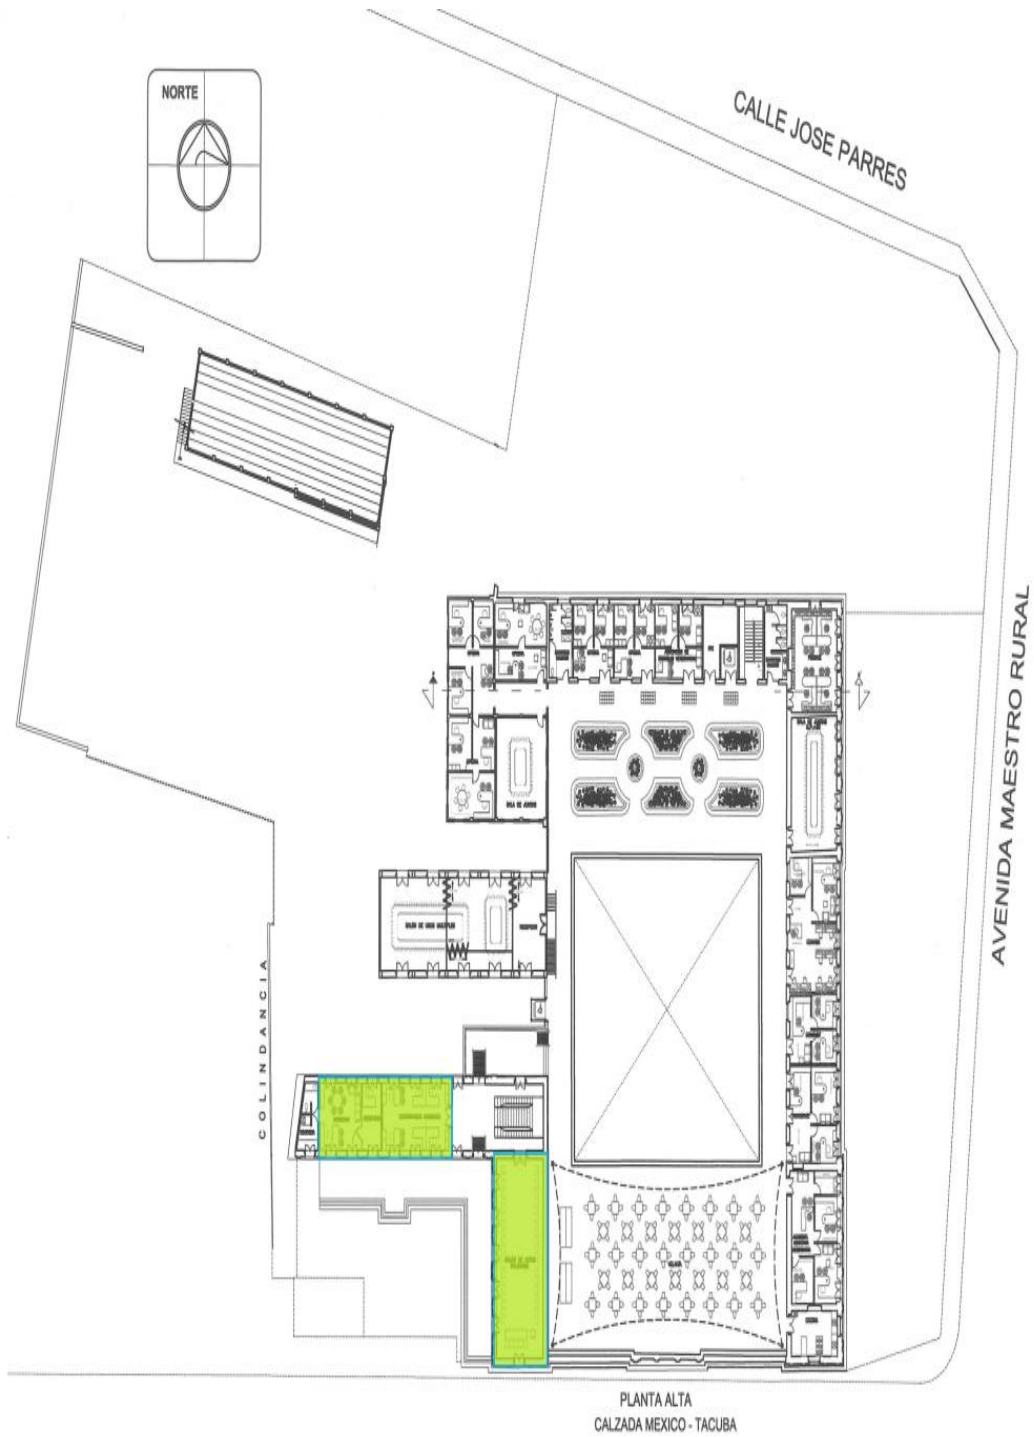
11 Cobertura IDF planta alta <sup>42</sup>
